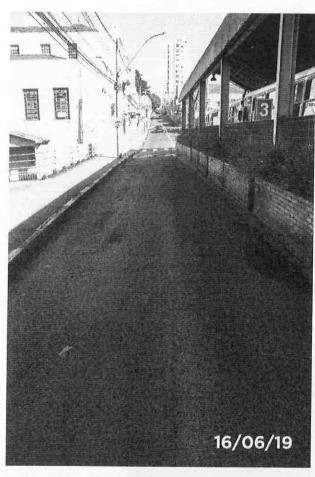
Vista da fissura no pavimento asfáltico com pequenos buracos, ondulações, infiltração causada pelo jardim do terminal rodoviário. Observa-se também a iluminação pública.
